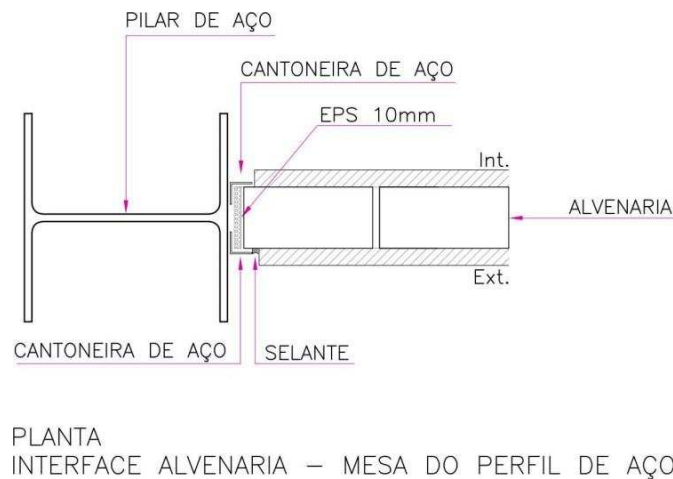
Detalhe da interface entre alvenaria externa e mesa do pilar de aço.
